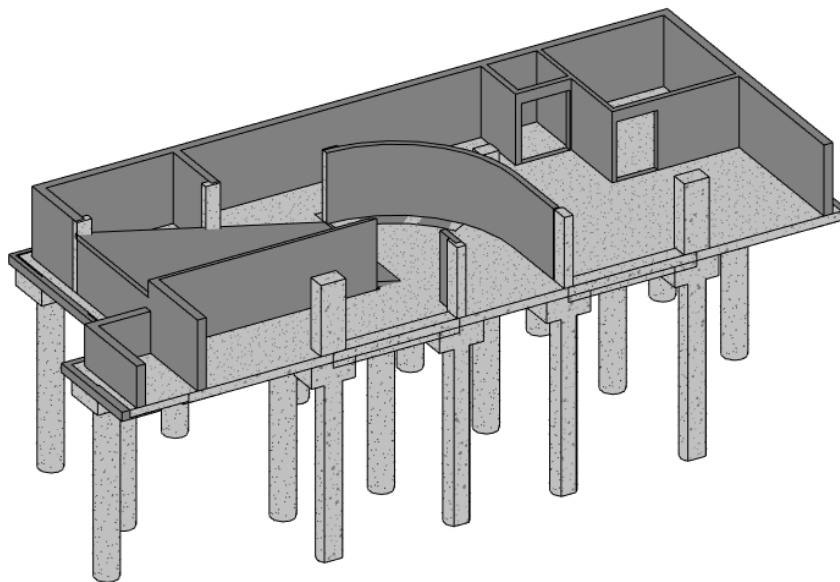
Corte tridimensional do piso da cave em LOD 200.
